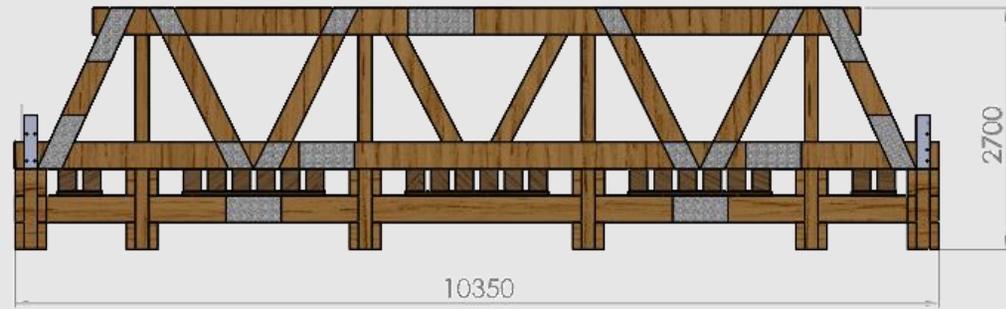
Vista longitudinal puente 10 m unidireccional.
